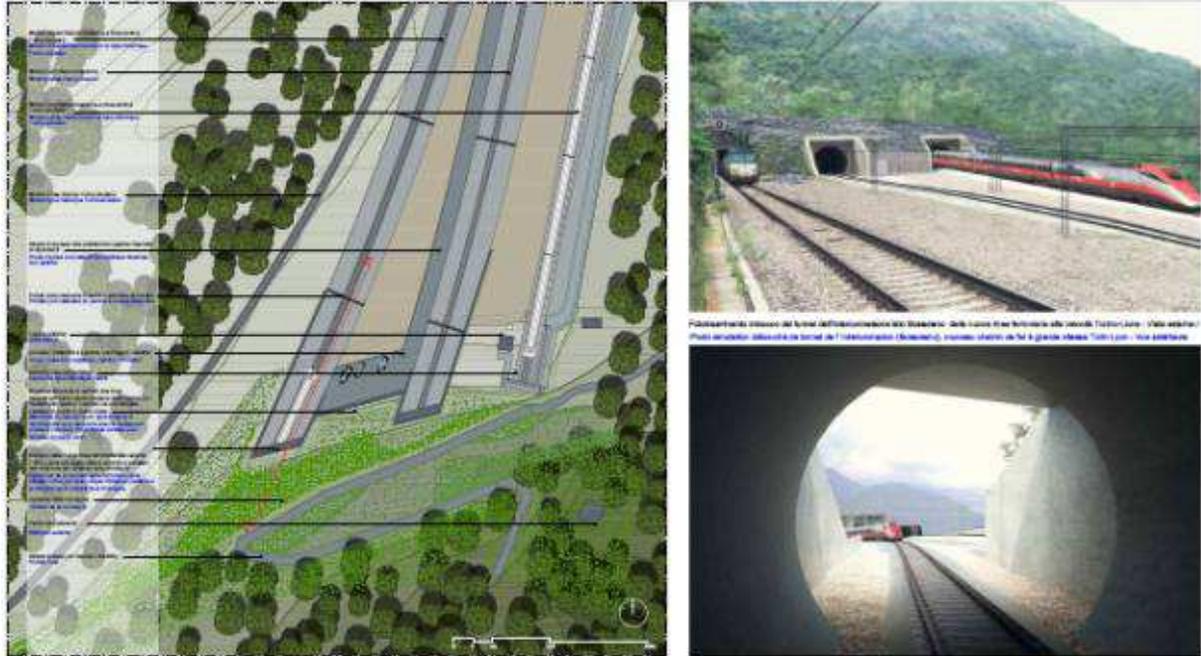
Tunnel dell'Interconnessione imbocco lato Bussoleno
